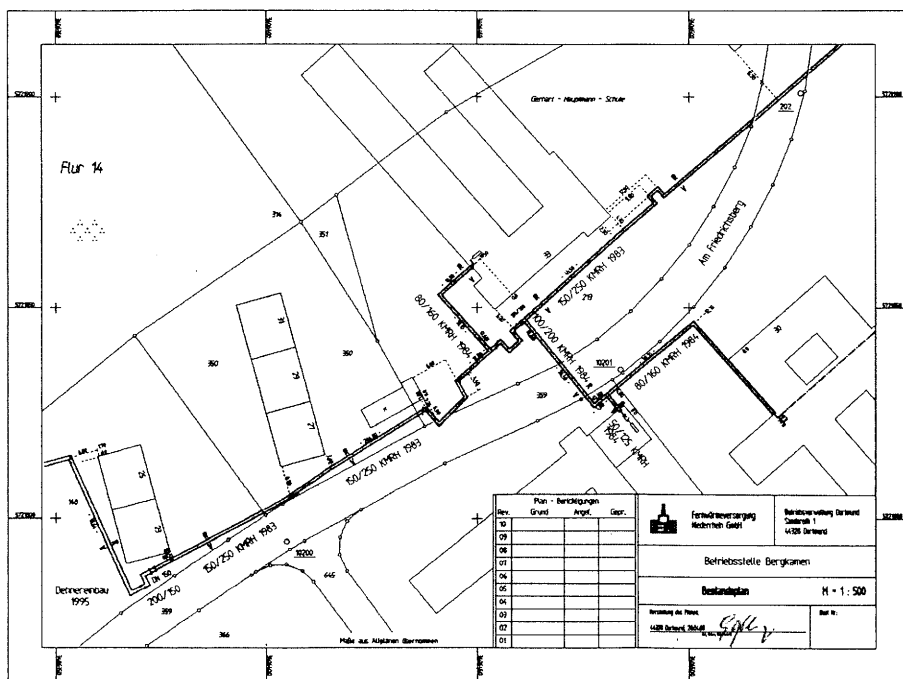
Lageplan eines 258 m langen Leitungsabschnittes
